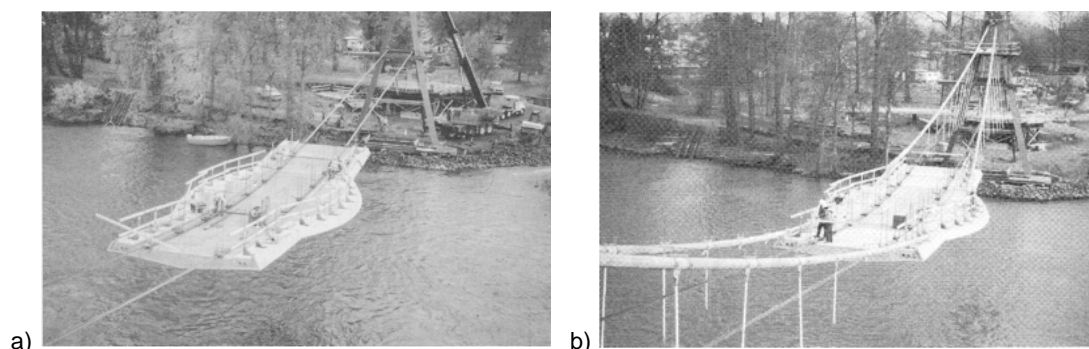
Willamette River Bridge, OR, USA – segmento central do tabuleiro a) suspenso nos cabos de erecção
